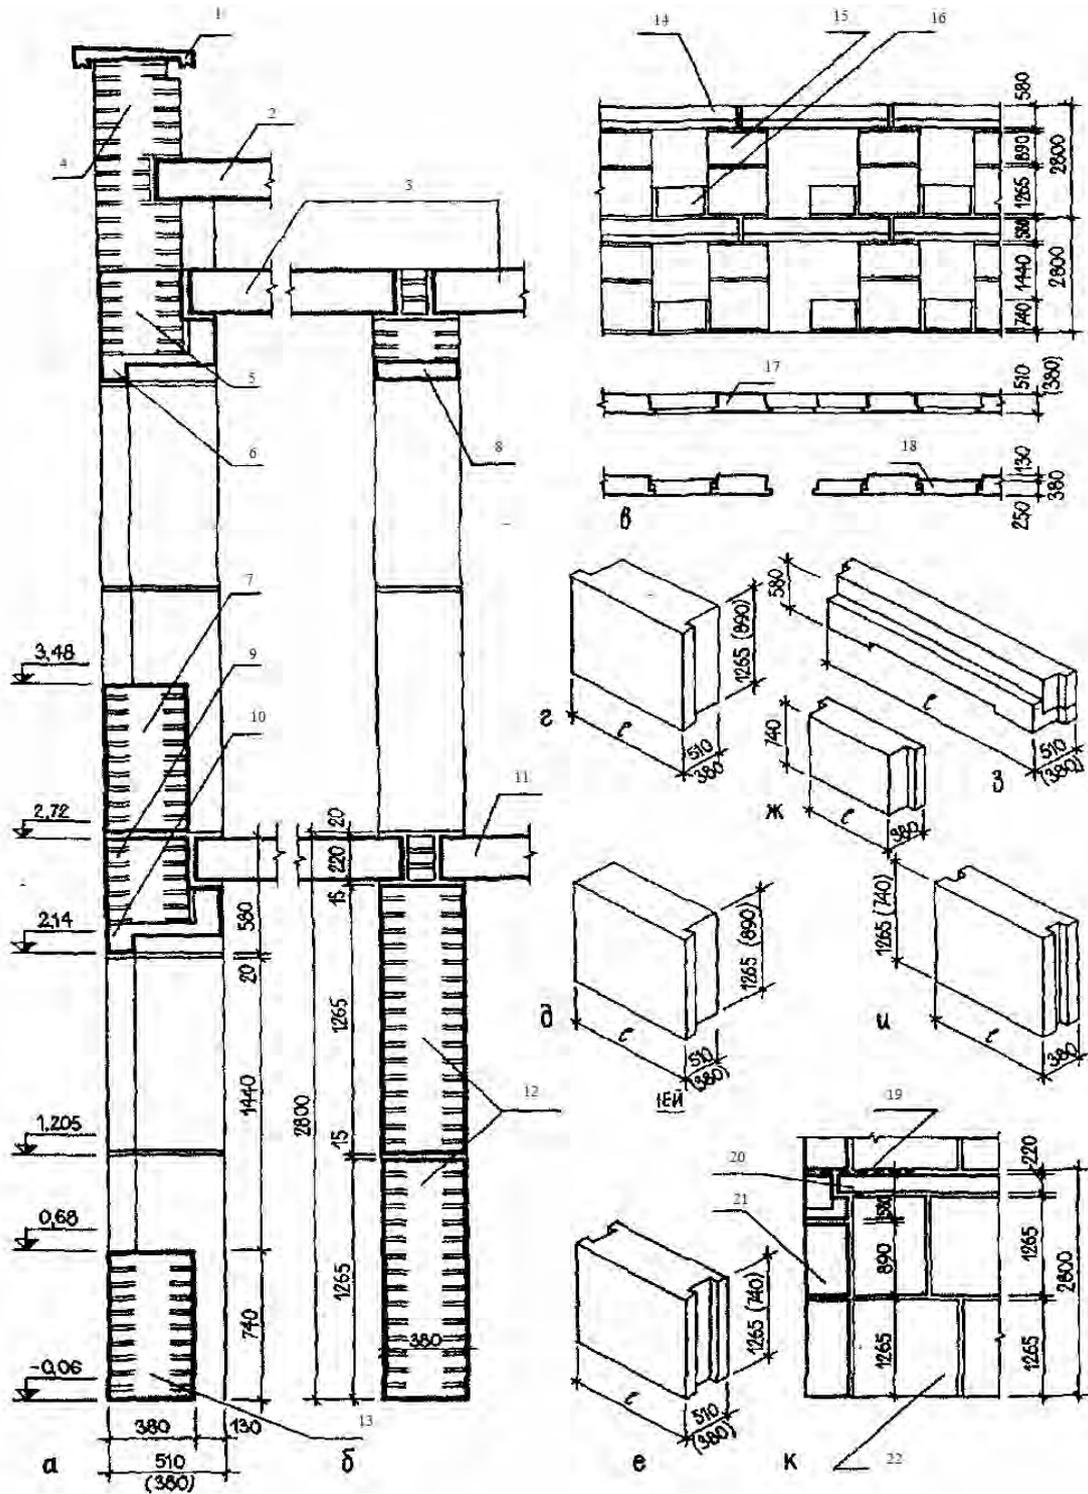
Основные крупные кирпичные блоки и детали стен из них: *а, б* — порядовка наружной и внутренней стены; *в* — разрезка наружной стены из крупных кирпичных блоков; *г* — простеночный блок; *д* — угловой блок наружной стены; *е* — блок торцевой стены; *ж* — подоконный блок; *з* — перемычный блок; *и* — блок внутренней стены; *к* — вертикальное сечение наружной стены и примыкание к ней внутренней стены: *1* — парпетная плита; *2* — панель покрытия; *3, 11, 20* — панель перекрытия; *4* — кладка; *5, 9, 14* — перемычный блок; *6* — поддон блока; *7, 13, 16, 18* — подоконный блок; *8* — плитная перемычка; *10* — железобетонный поддон; *12* — блоки внутренней стены; *15, 17* — простеночный блок; *19* — сетка; *21* — наружная стена; *22* — внутренняя стена
